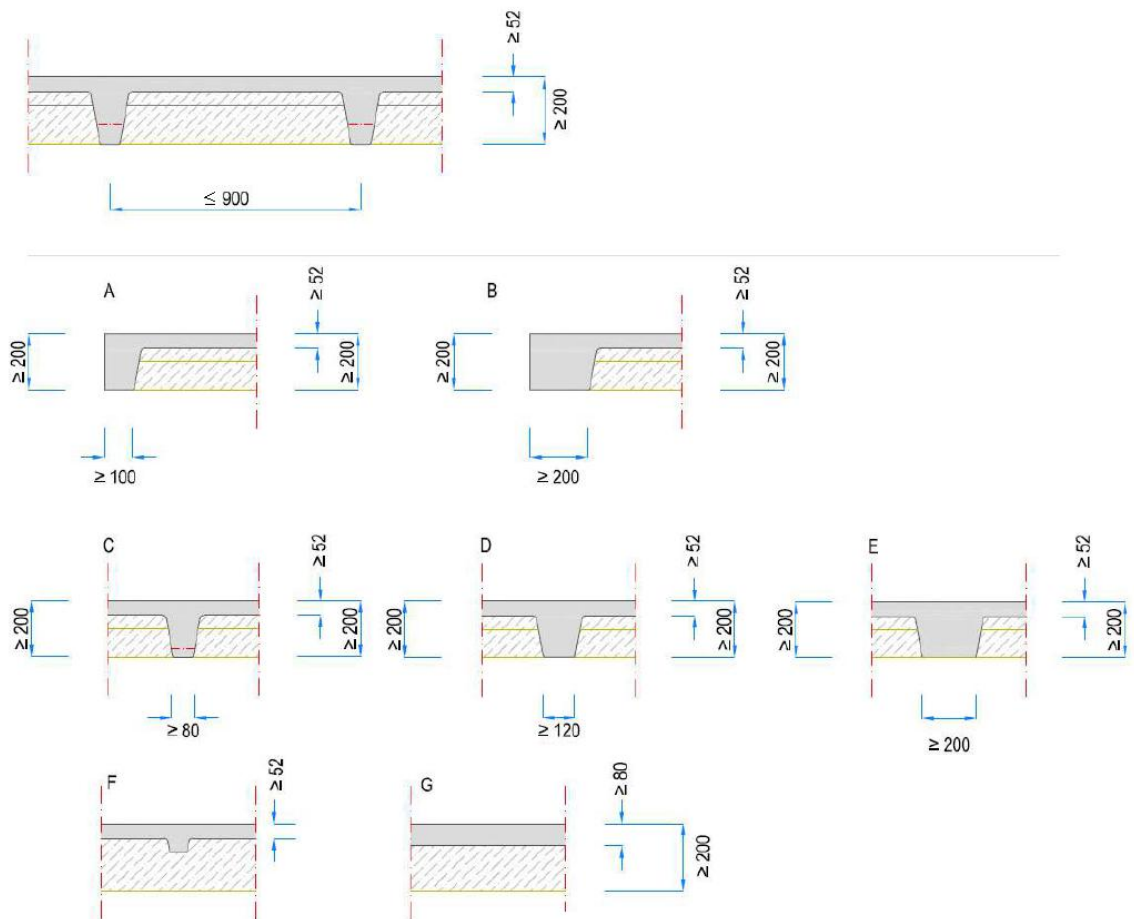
Sección estructural con aislamiento entre nervios trapezoidales.
